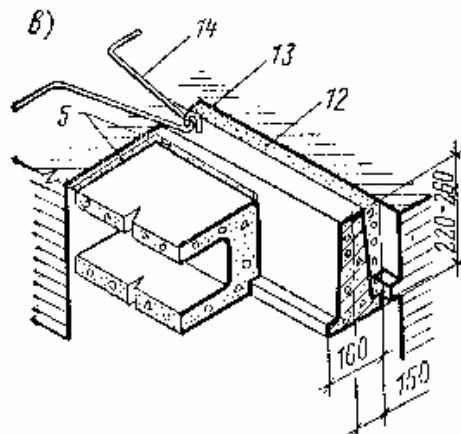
Перекрытие по железобетонным балкам (анкеровка): 5 — раствор; 12 — шлакобетон; 13 — монтажная петля; 14 — анкер.
